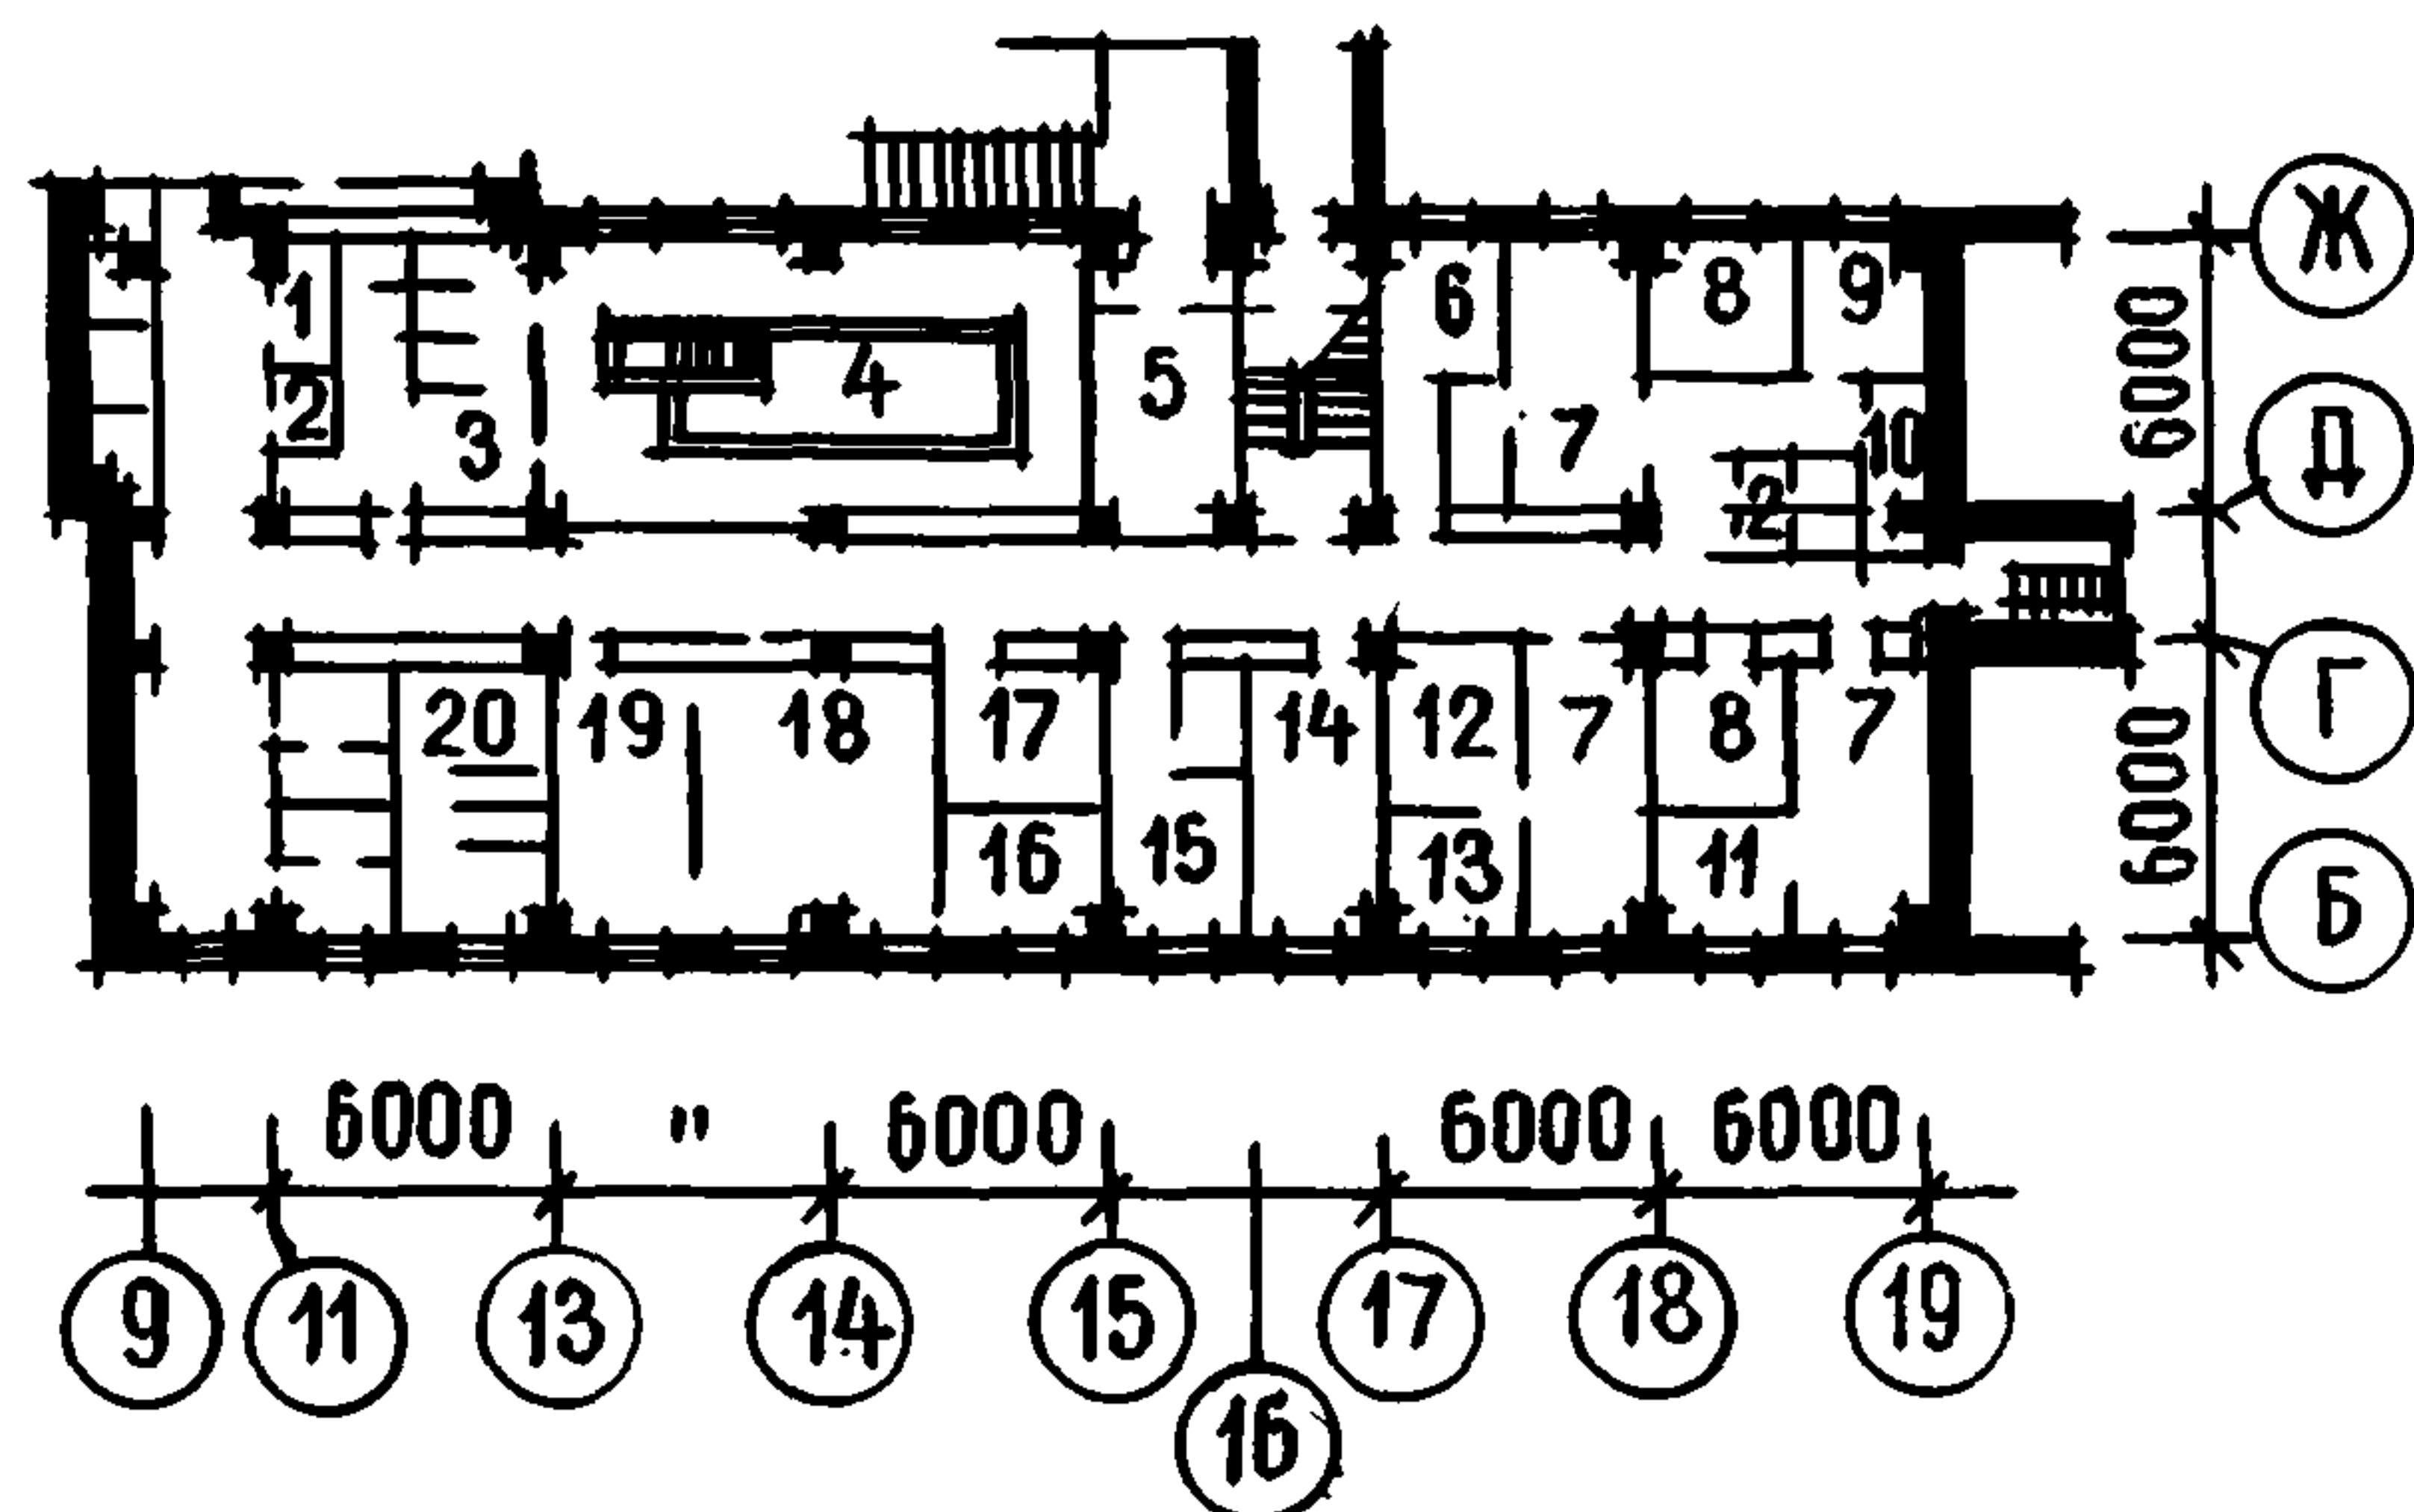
План 1 этажа (вариант для лечения желудочно-кишечных заболеваний):
